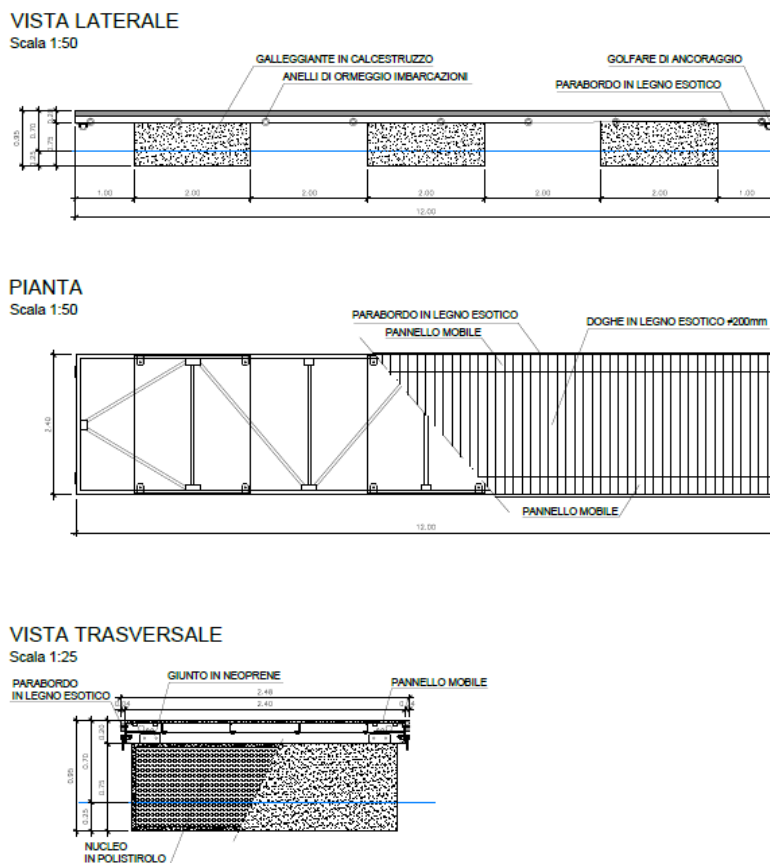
Pianta, vista laterale e trasversale tipologica dei pontili. Estratto dalla tavola B15
